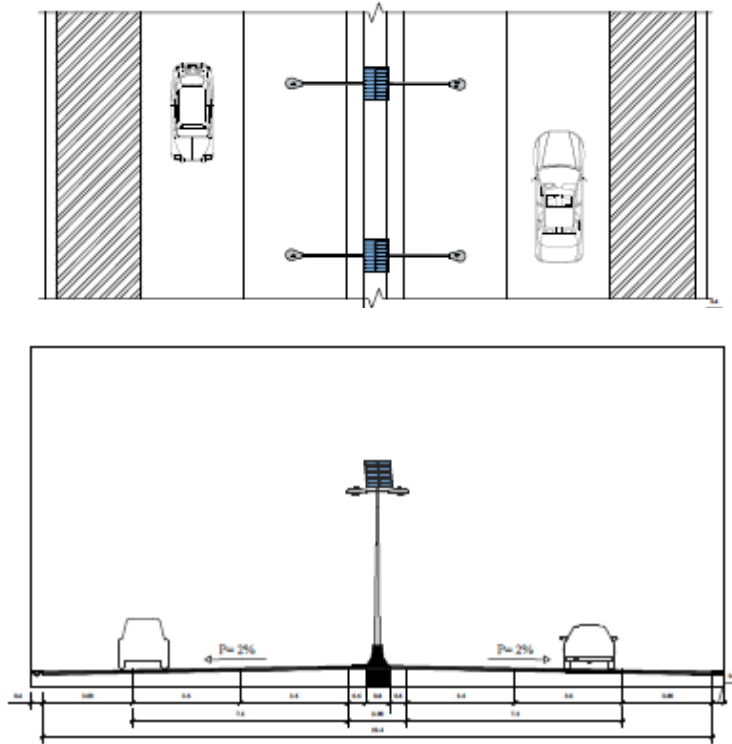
Planta y Sección Propuesta de la Autopista Urbana
